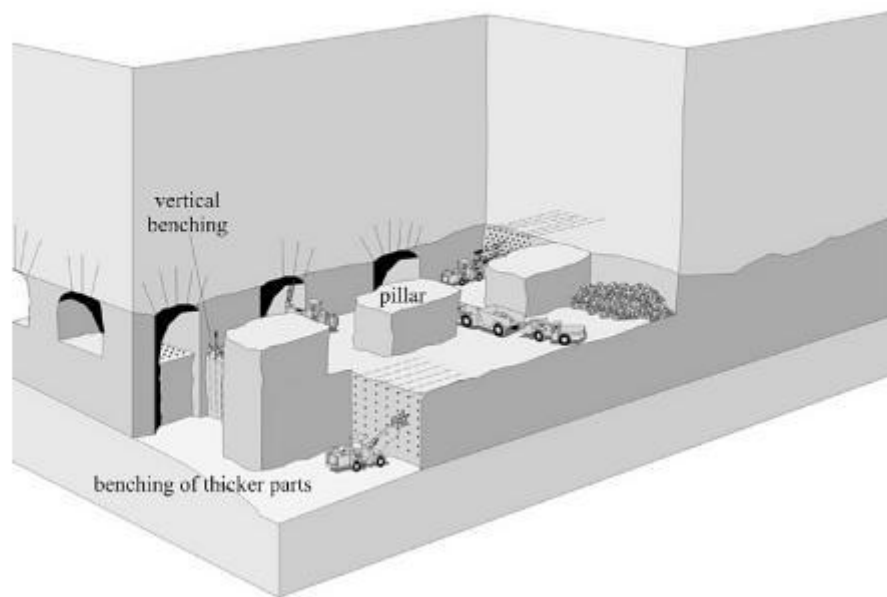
Aplicación de sistema de cámaras y pilares tomado de Escalante, K (2011).
